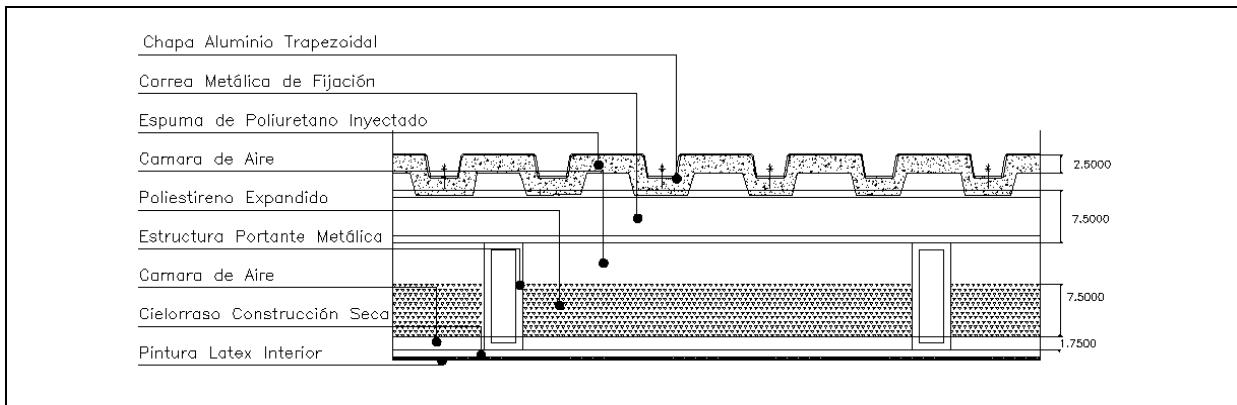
Detalle Cubierta Liviana de Chapa de Aluminio Trapezoidal (Reciclado). Aislación de Poliuretano Inyectado.
